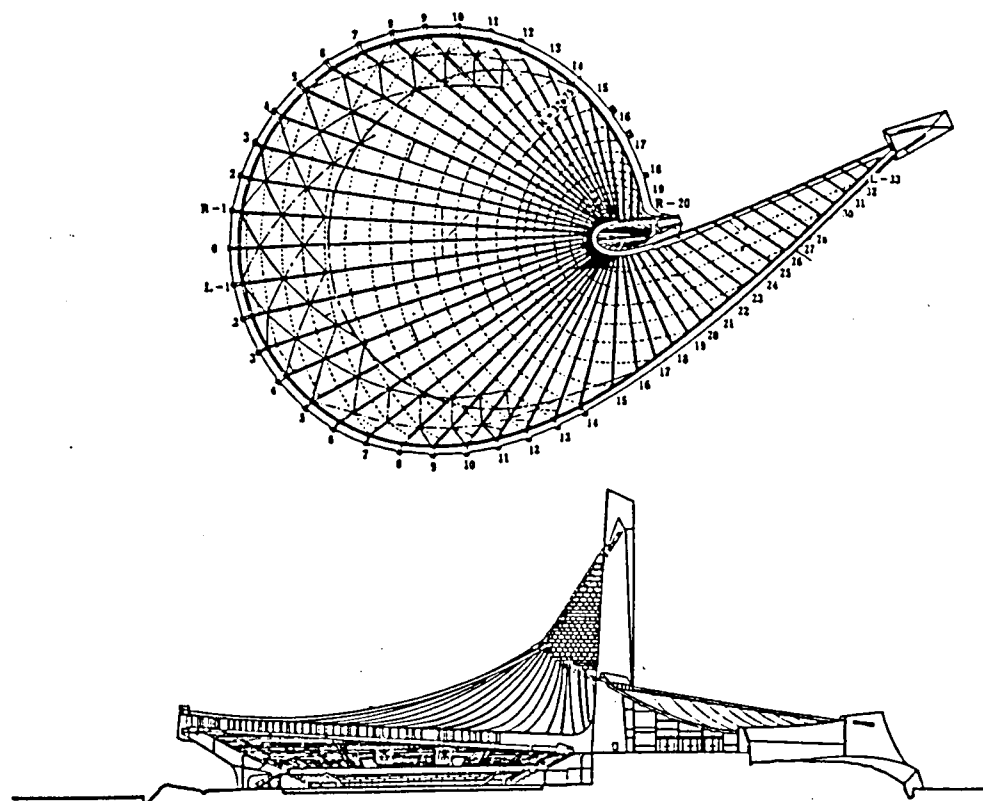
Desenho da planta e alçado do "Minor Gymnasium of the Tokyo Olympic Indoor Stadium"
